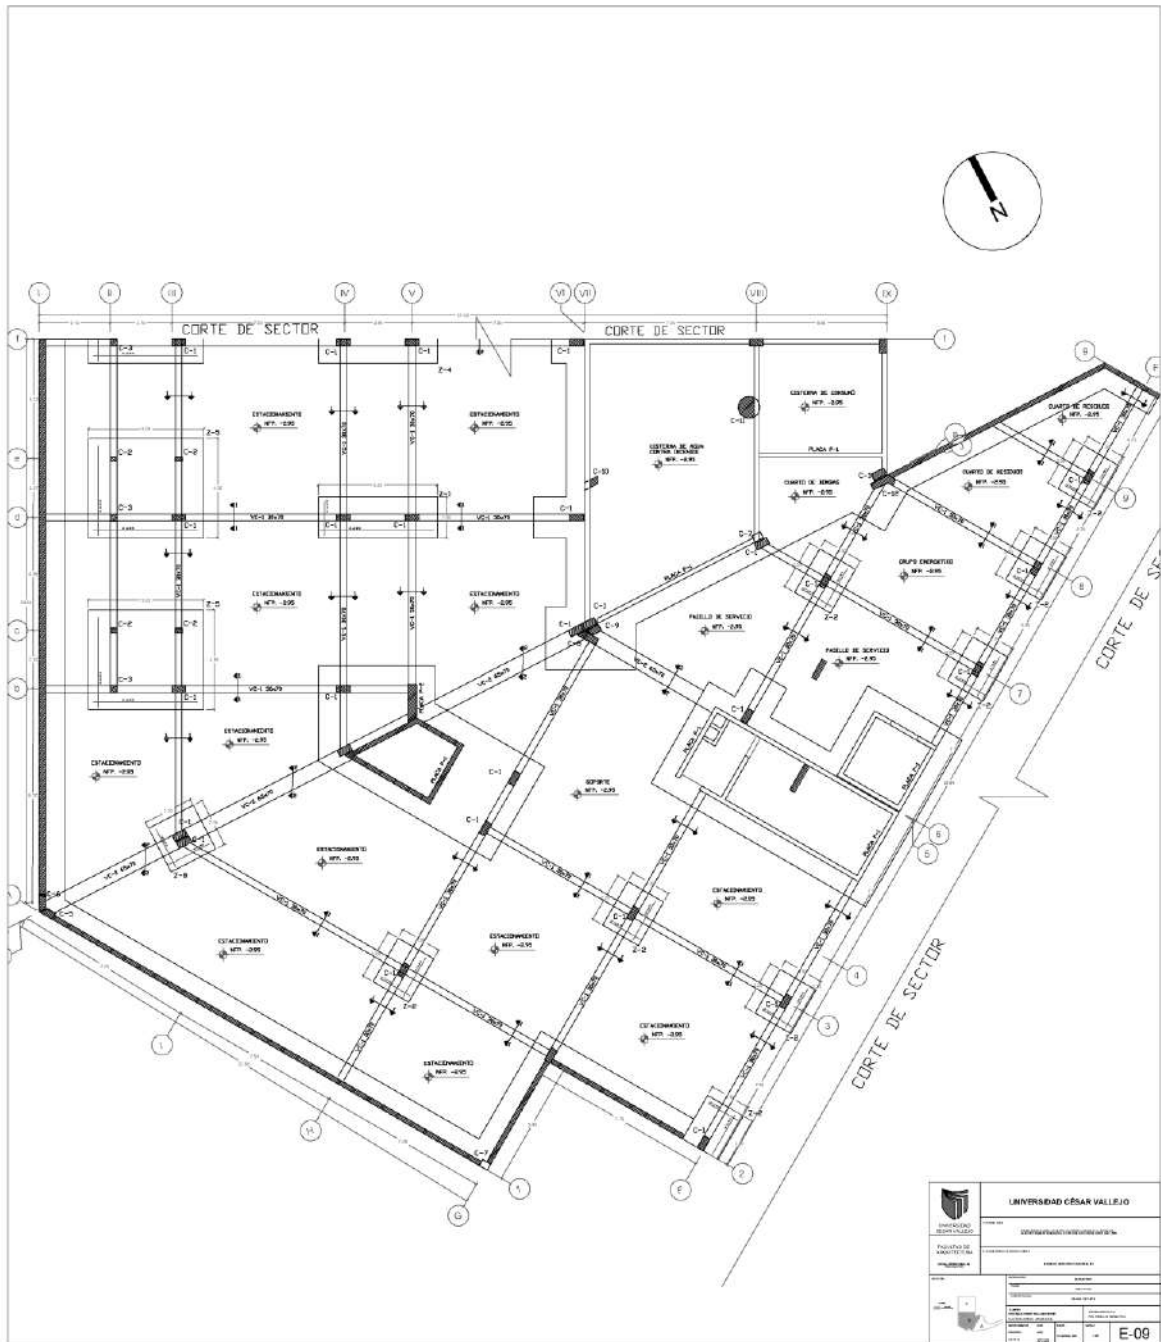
Cimentación - Sector B - ESTRUCTURAS
